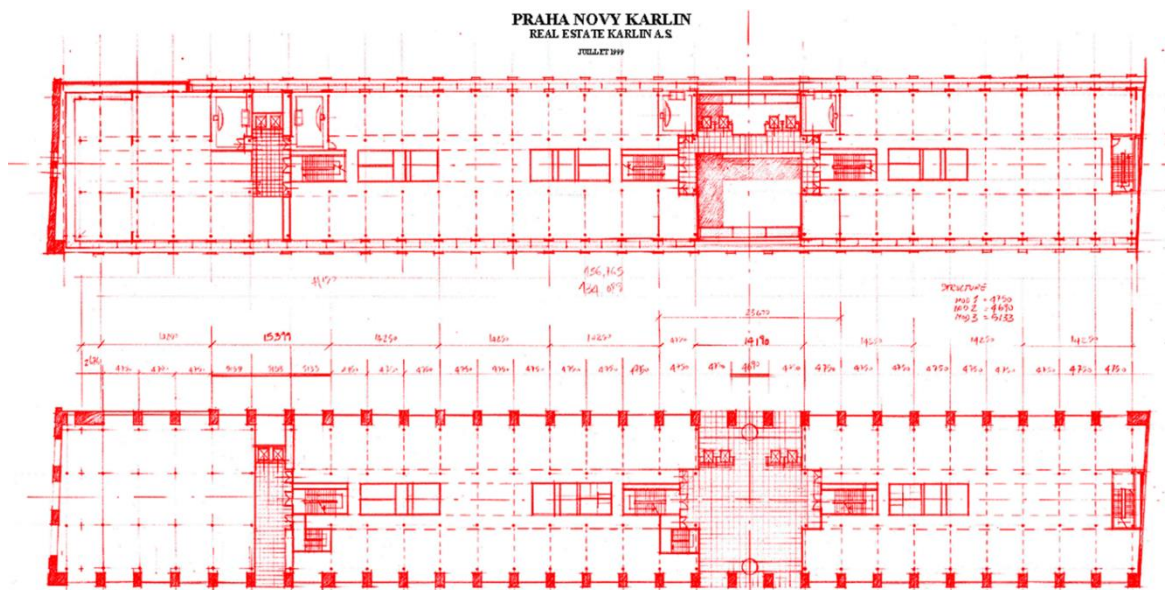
PLANS DE CORSO KARLIN SOURCE : ARCHITECTE RICARDO BOFILL
